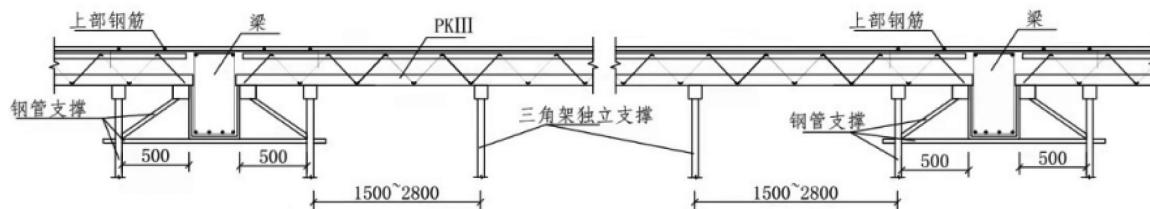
与混凝土梁搭接浇筑叠合层混凝土时临时支撑示意图
